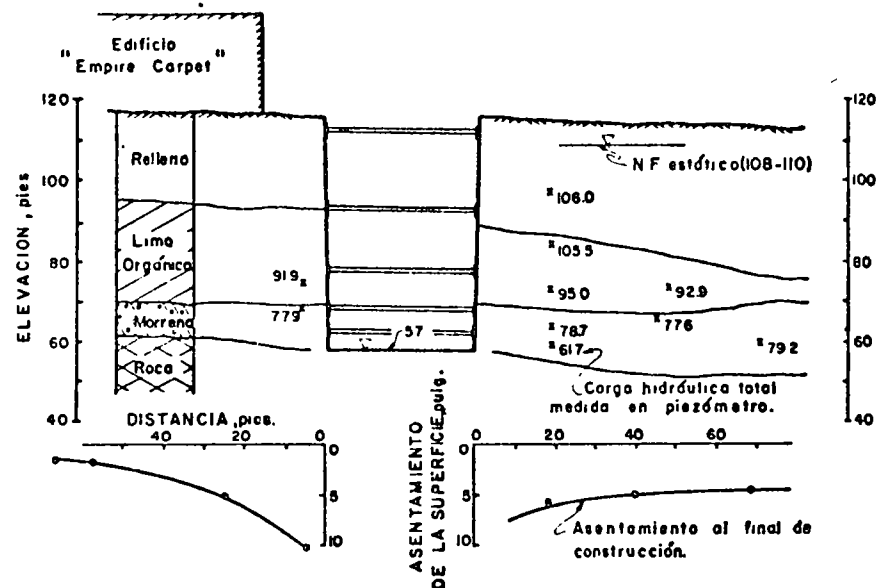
SECCION TRANSVERSAL EN EXCAVACION PARA METRO DE BOSTON, MOSTRANDO CAMBIOS EN CARGA HIDRAULICA TOTAL Y ASENTAMIENTO SUPERFICIAL CAUSADO POR LA EXCAVACION Y EL DRENAJE.
